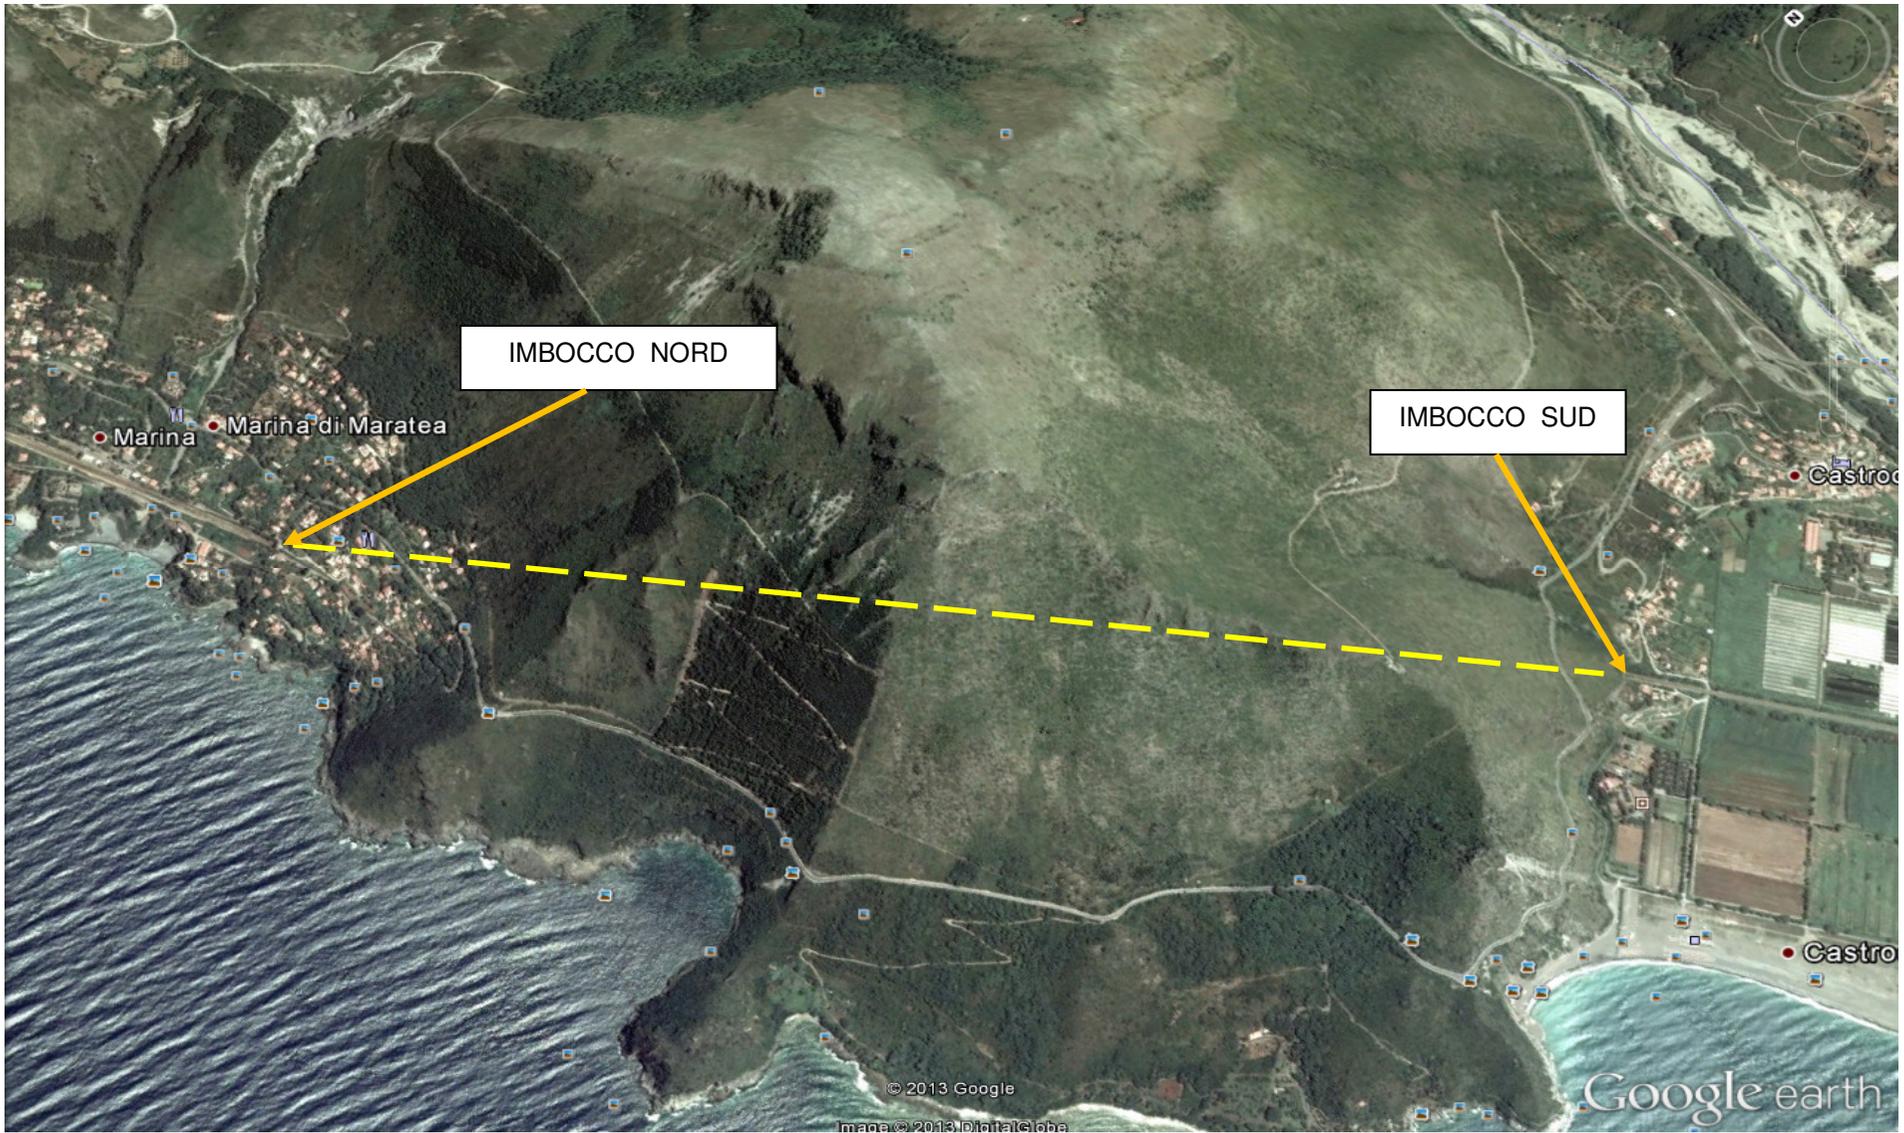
ANDAMENTO PLANIMETRICO CON IMBOCCHI
